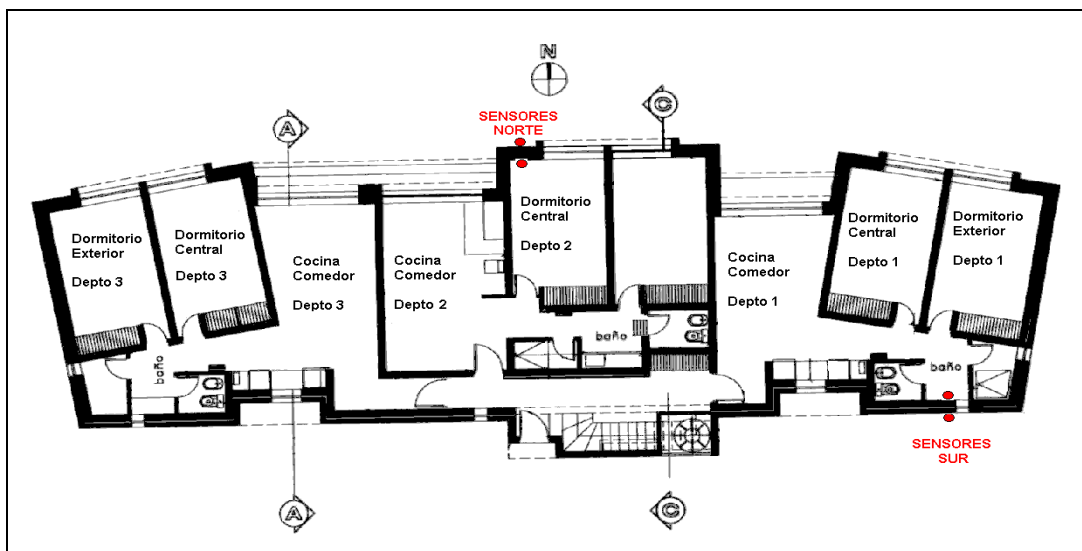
Vista en planta del edificio y ubicación de los sensores de temperatura sobre muros norte (planta baja) y sur (planta alta).
